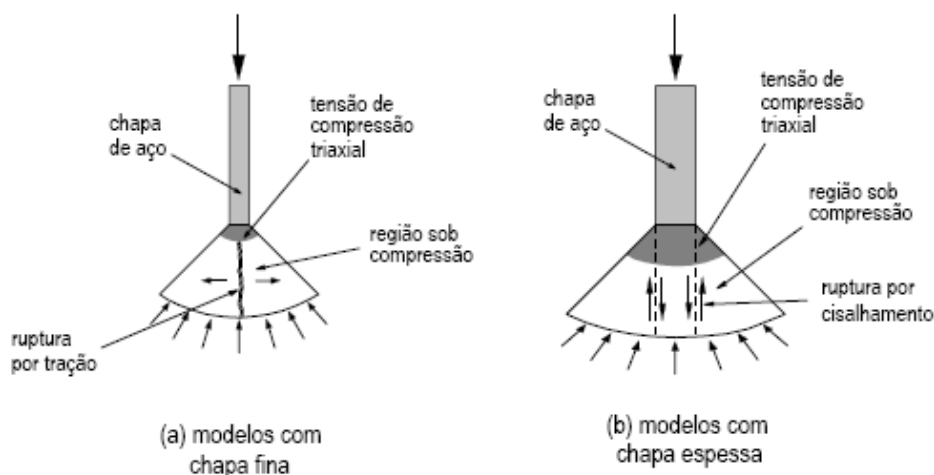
Condições de ruptura do concreto em função da espessura, Veríssimo (2007).
